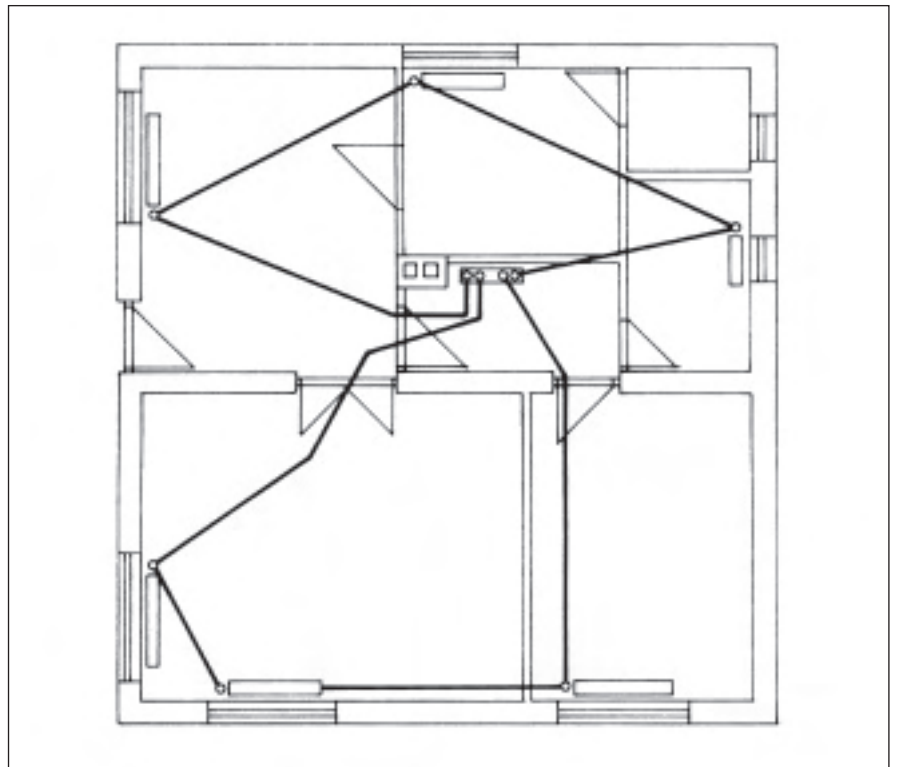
Instalace ústředního vytápění při použití různých materiálů
